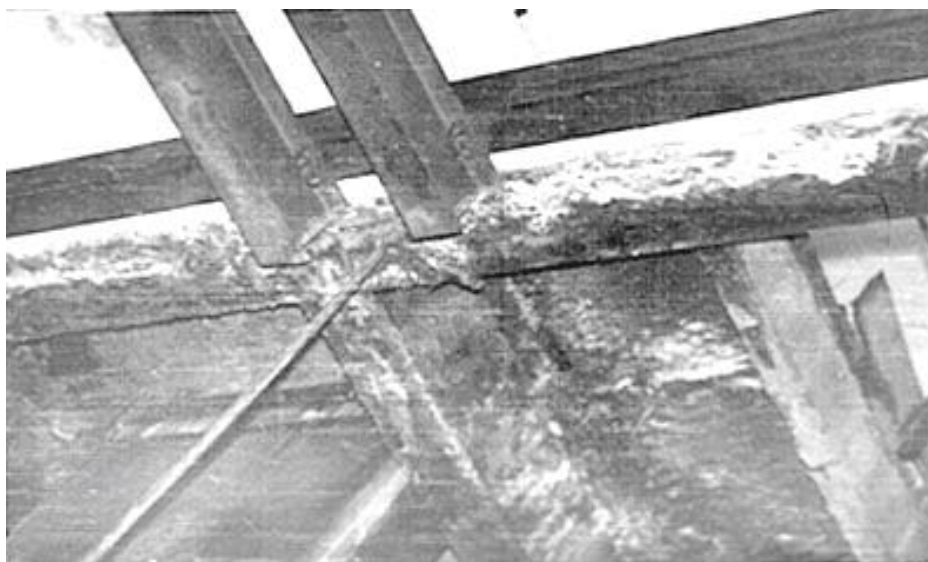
Коррозия железобетонных конструкций перекрытия под воздействием водных растворов глицерина (фото автора)
